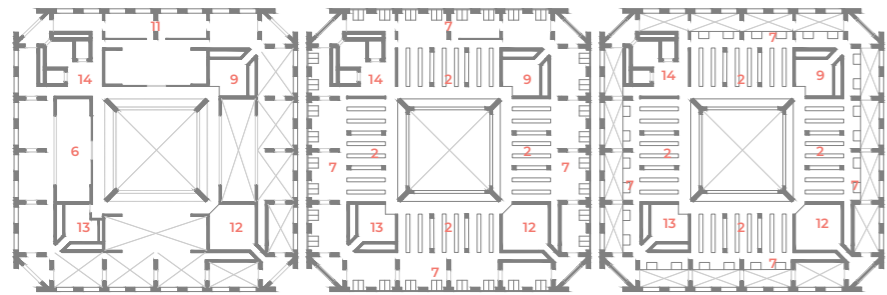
Planta de Implantação de 1967, Louis Kahn.
